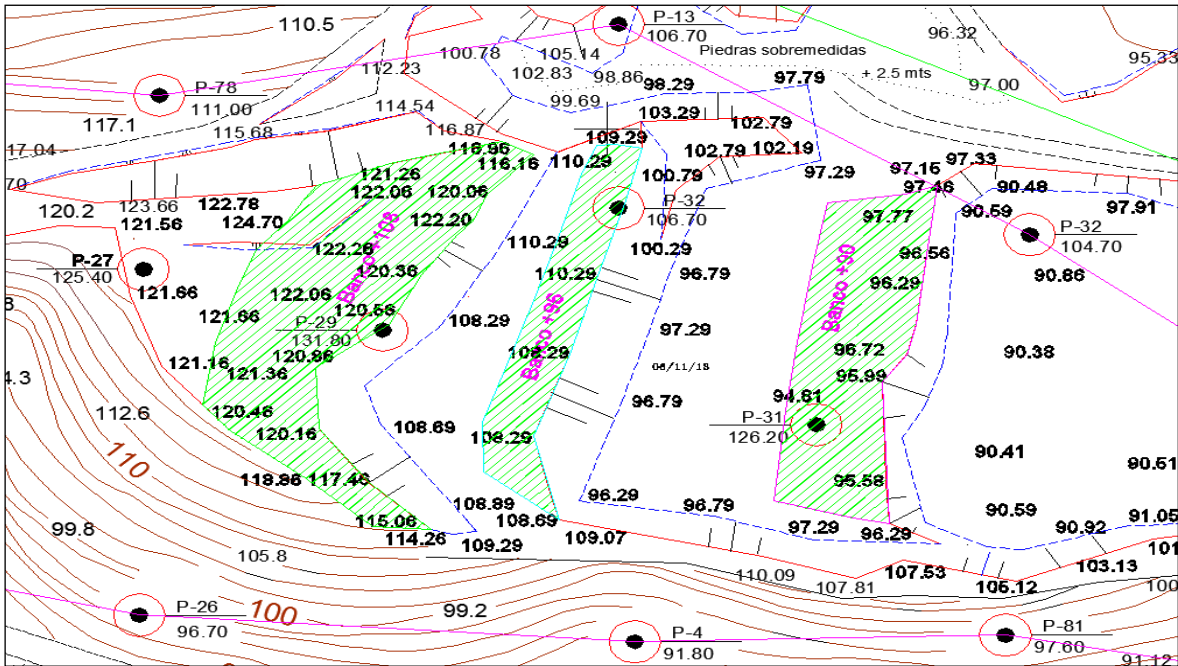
Vista en planta de la extracción planificada en las tres áreas
